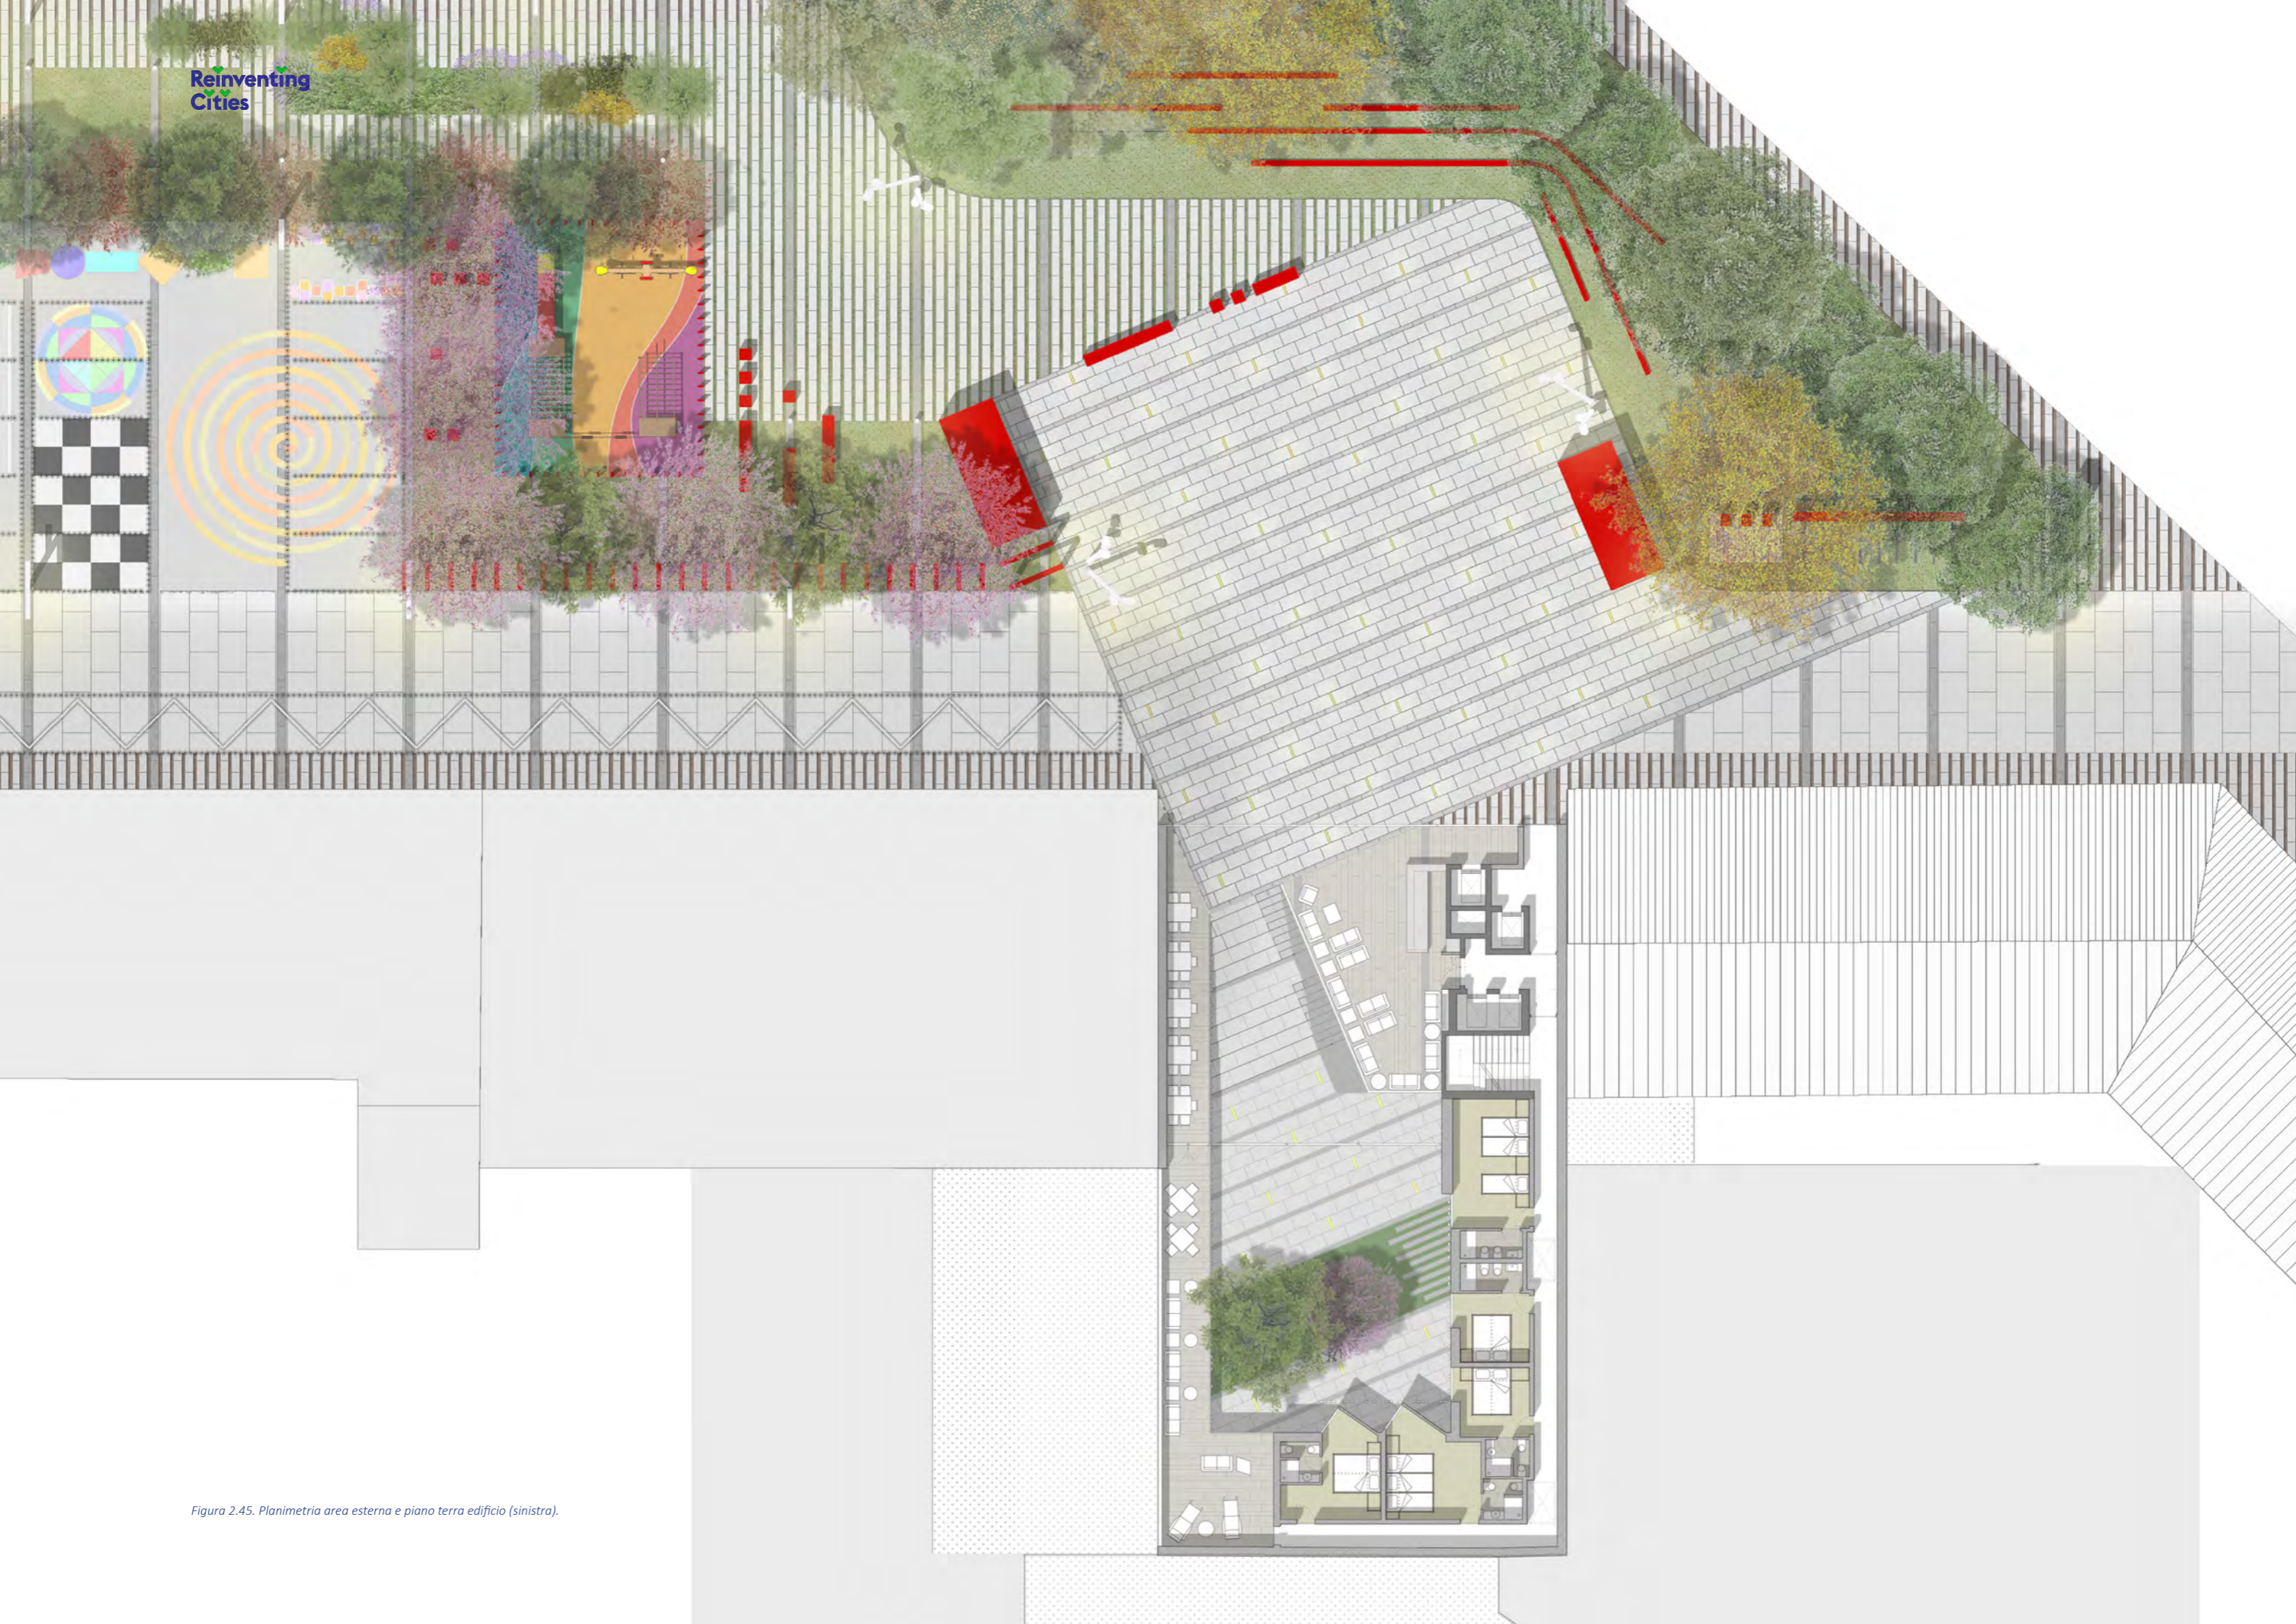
Planimetria area esterna e piano terra edificio (sinistra).
